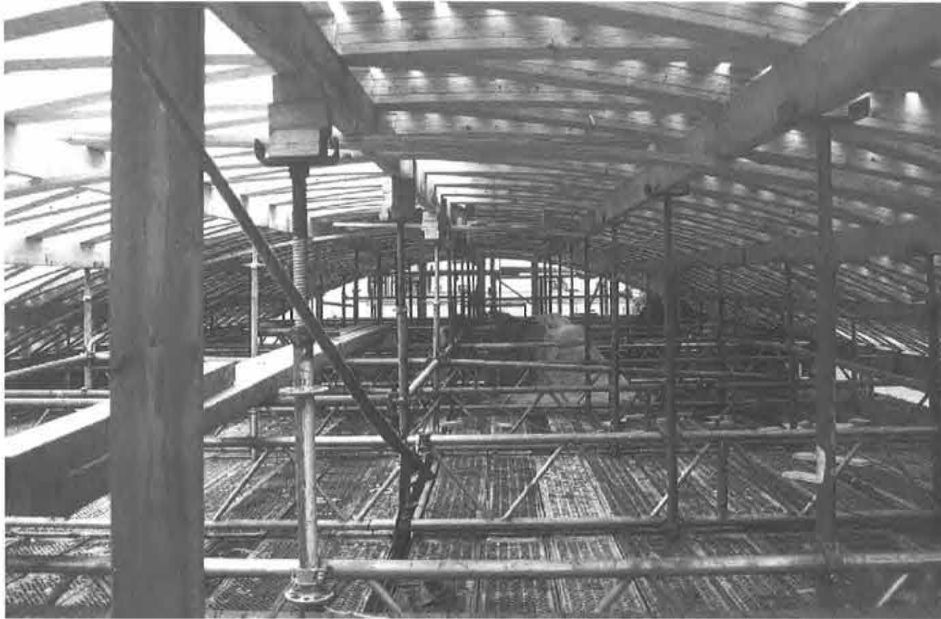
Linienförmiges Lehrgerüst beim Bau einer Tonnenschale als Brettrippenkonstruktion.
